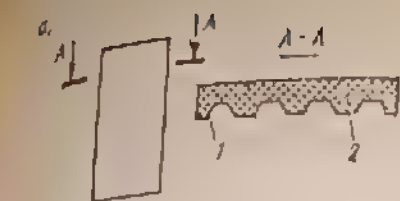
Стальные двухслойные панели покрытий зданий с утеплителем из пенополиуретана
